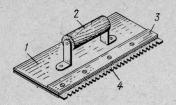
1 — полотно рабочее; 2 — держатель — обойма; 3 тулейка; 4 — ручка
